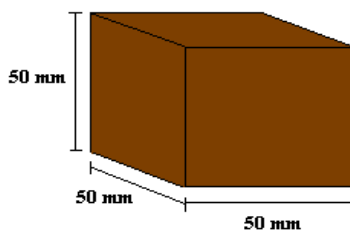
Dimensiones de probeta C 170/C 170M – 09.
